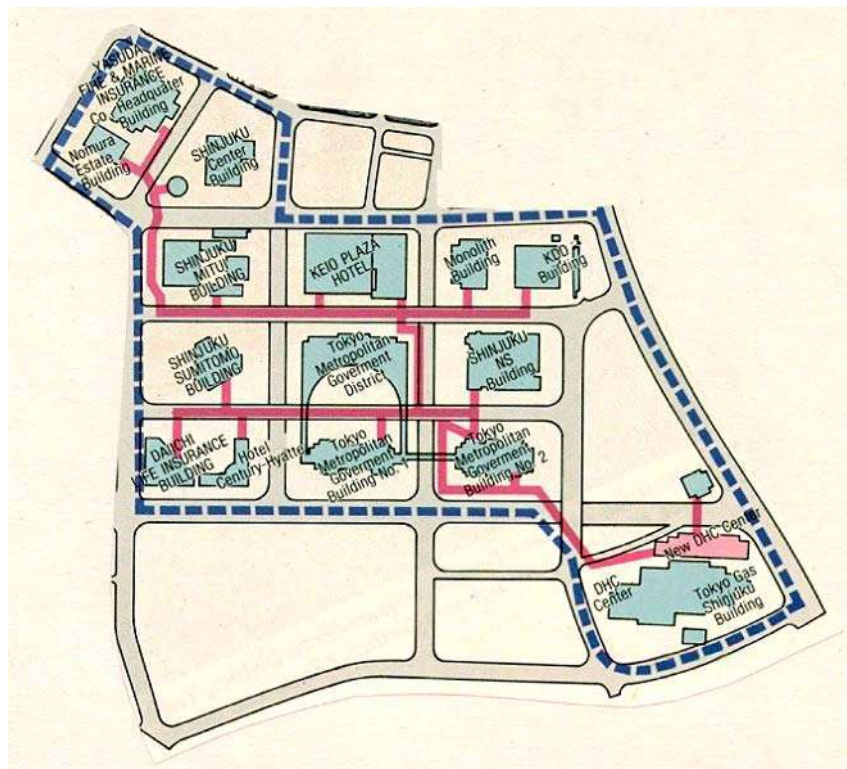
PLANTA DO PROJETO DISTRIAL
